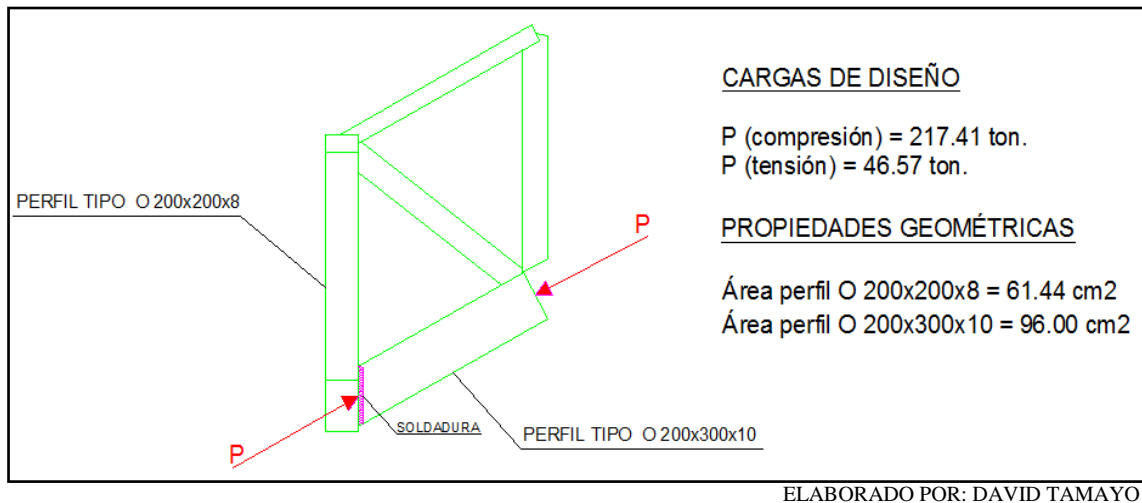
(Esquema de perfilería unida mediante soldadura)
